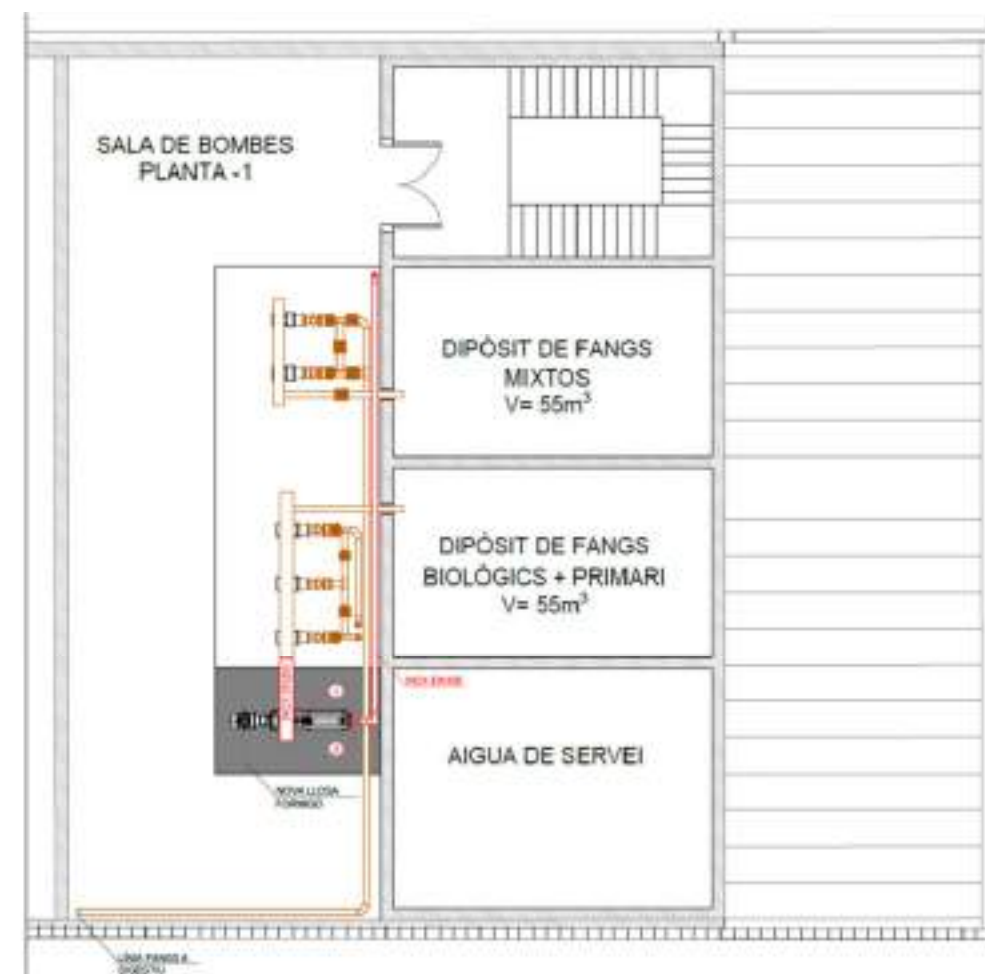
Planta d'implantació de l'equip de bombament de fang de rehidratació
